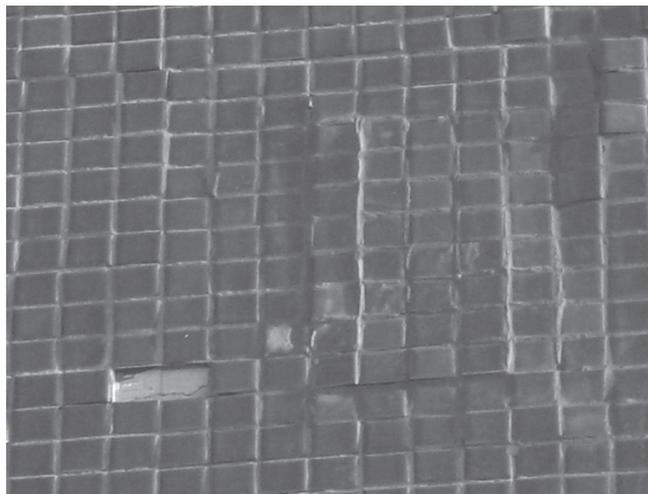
Detalhe da fachada já recuperada e novo destacamento do edifício C. Fonte: Arquivo próprio.
